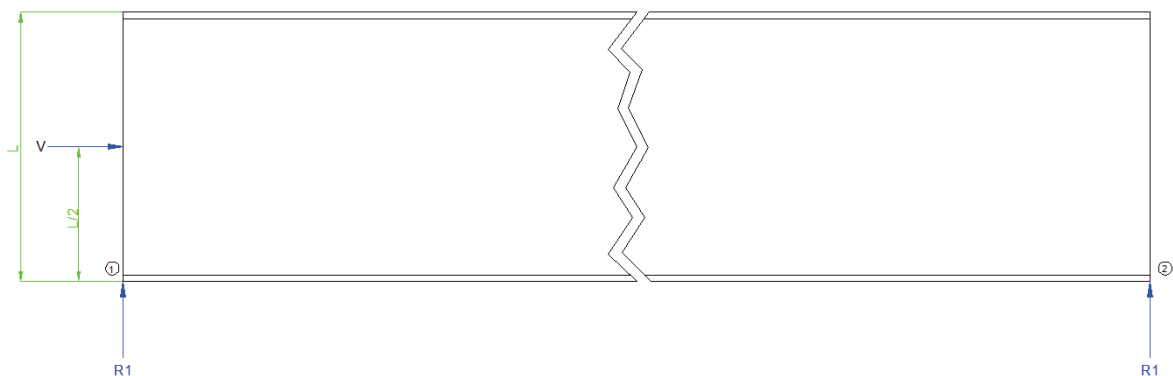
Carga de viento actuando longitudinalmente sobre la estructura
